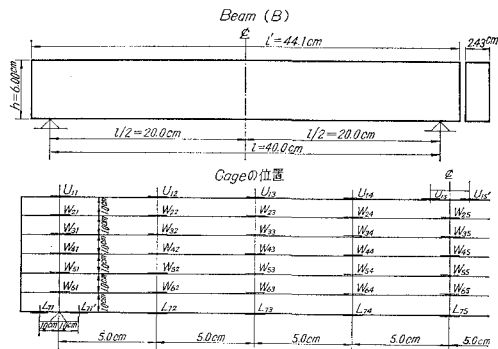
鋼矩形断面桁模型 Beam (B) の寸法及びゲージの位置
